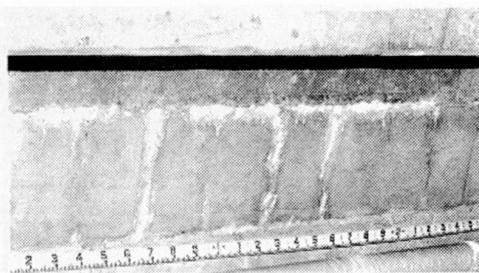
間詰部の鋼材に沿ったひび割れ
